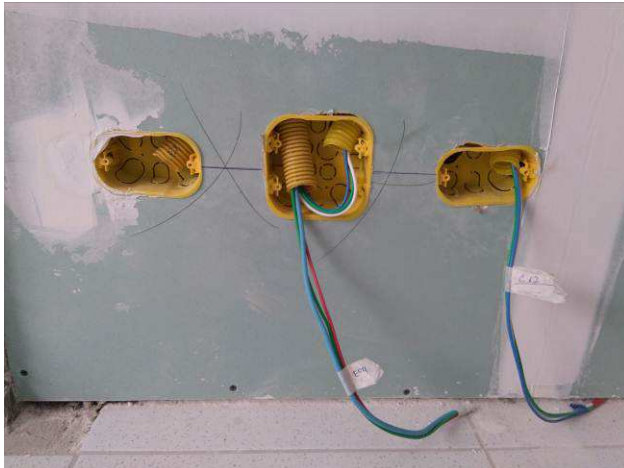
E: infraestrutura elétrica para paredes drywall térreo
